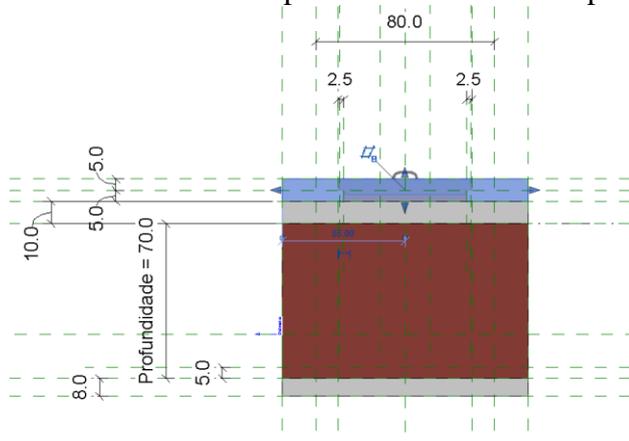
Vista superior dos parâmetros da caixa de passagem.
